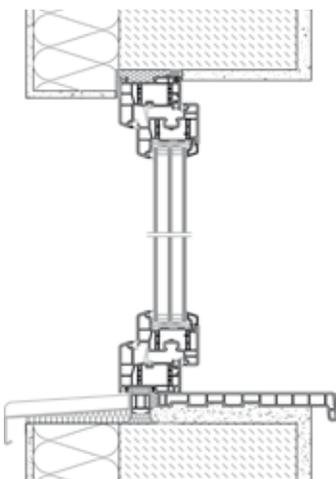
Fenster mauerwerksbündig nach außen eingebaut
